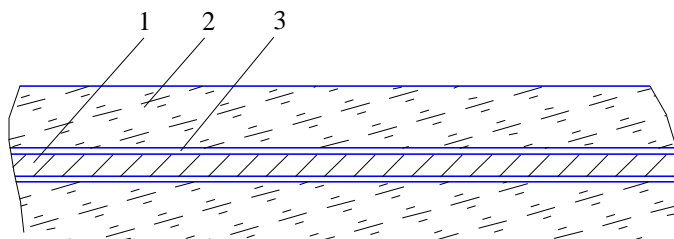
Конструкція шумопоглинального сендвіч-екрана (поперечний переріз):
